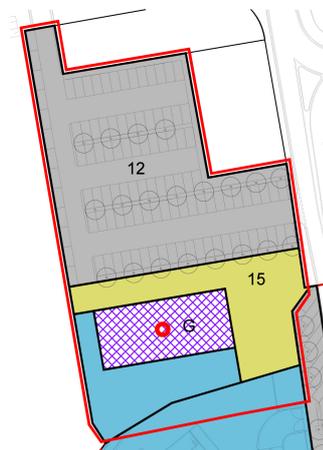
| Dettaglio del Lotto 6 con inserimento dell'asilo.
